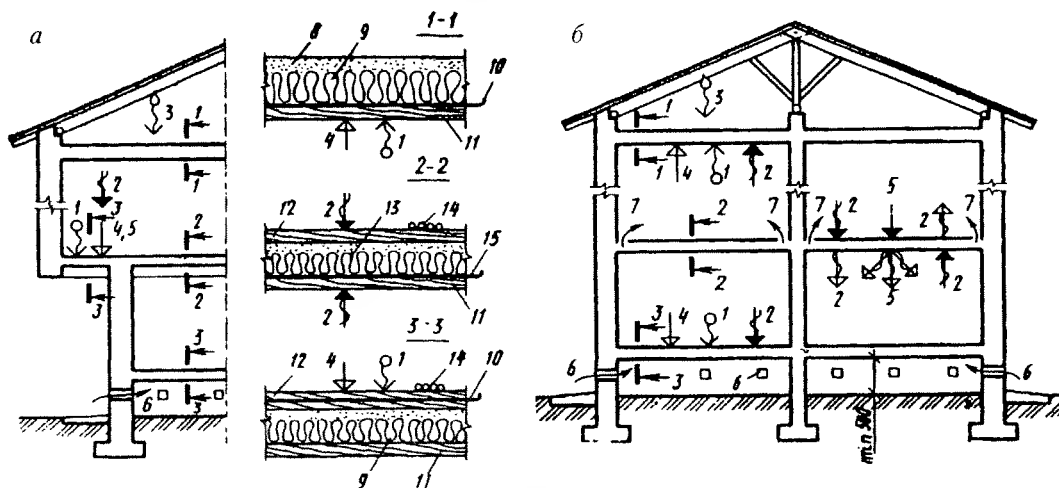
Перекрытия и основные воздействия на них (вертикальные нагрузки и горизонтальные силовые воздействия не показаны):
